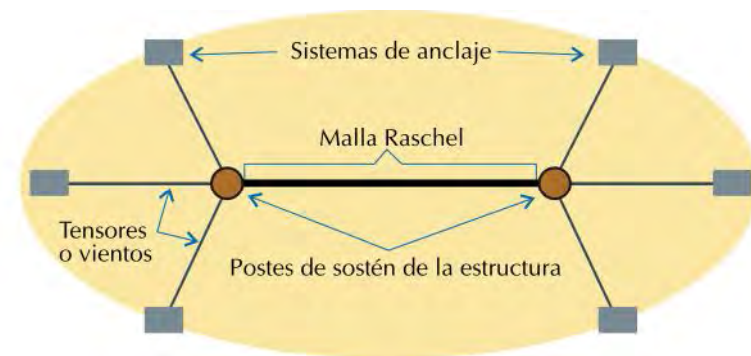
Vista en planta de la ubicación de los sistemas de anclaje, con respecto a los postes que sostienen la estructura.
